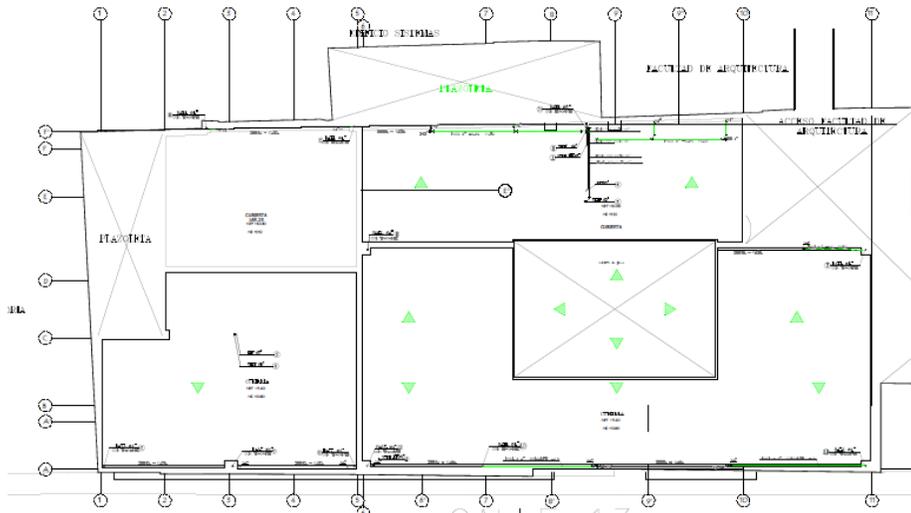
Cubierta Bloque I / Bajantes de agua lluvia Planimetría suministrada por la planta física de la UGC
